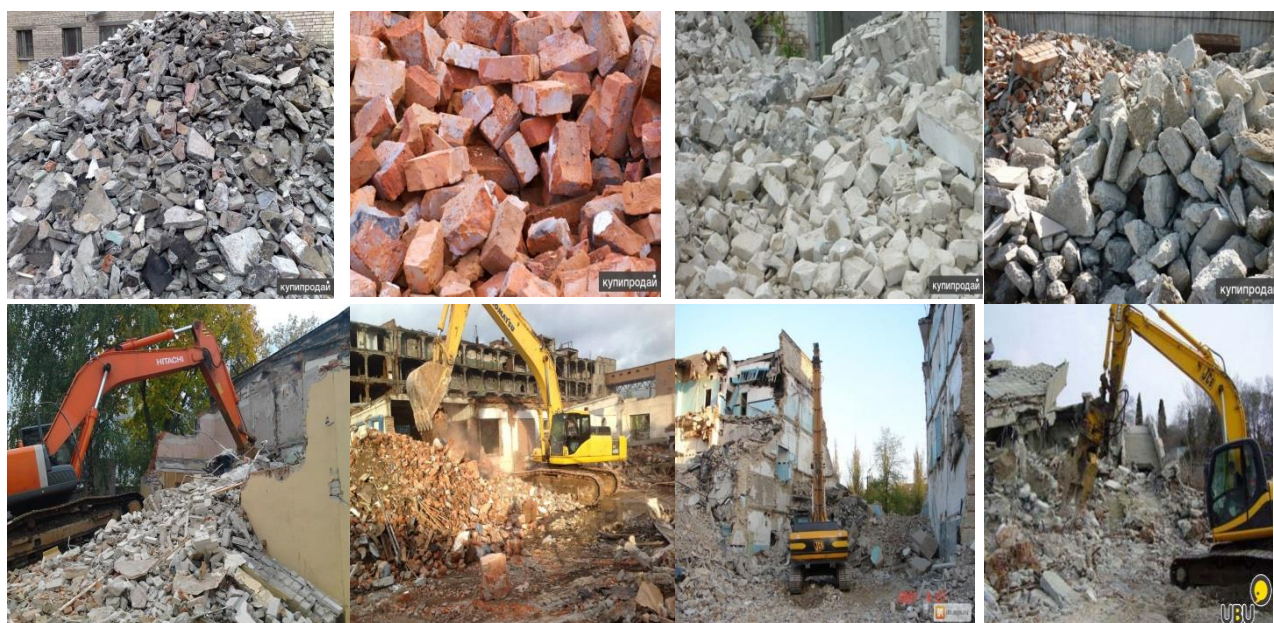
Виды разрушенного бетона, кирпича, арматур
